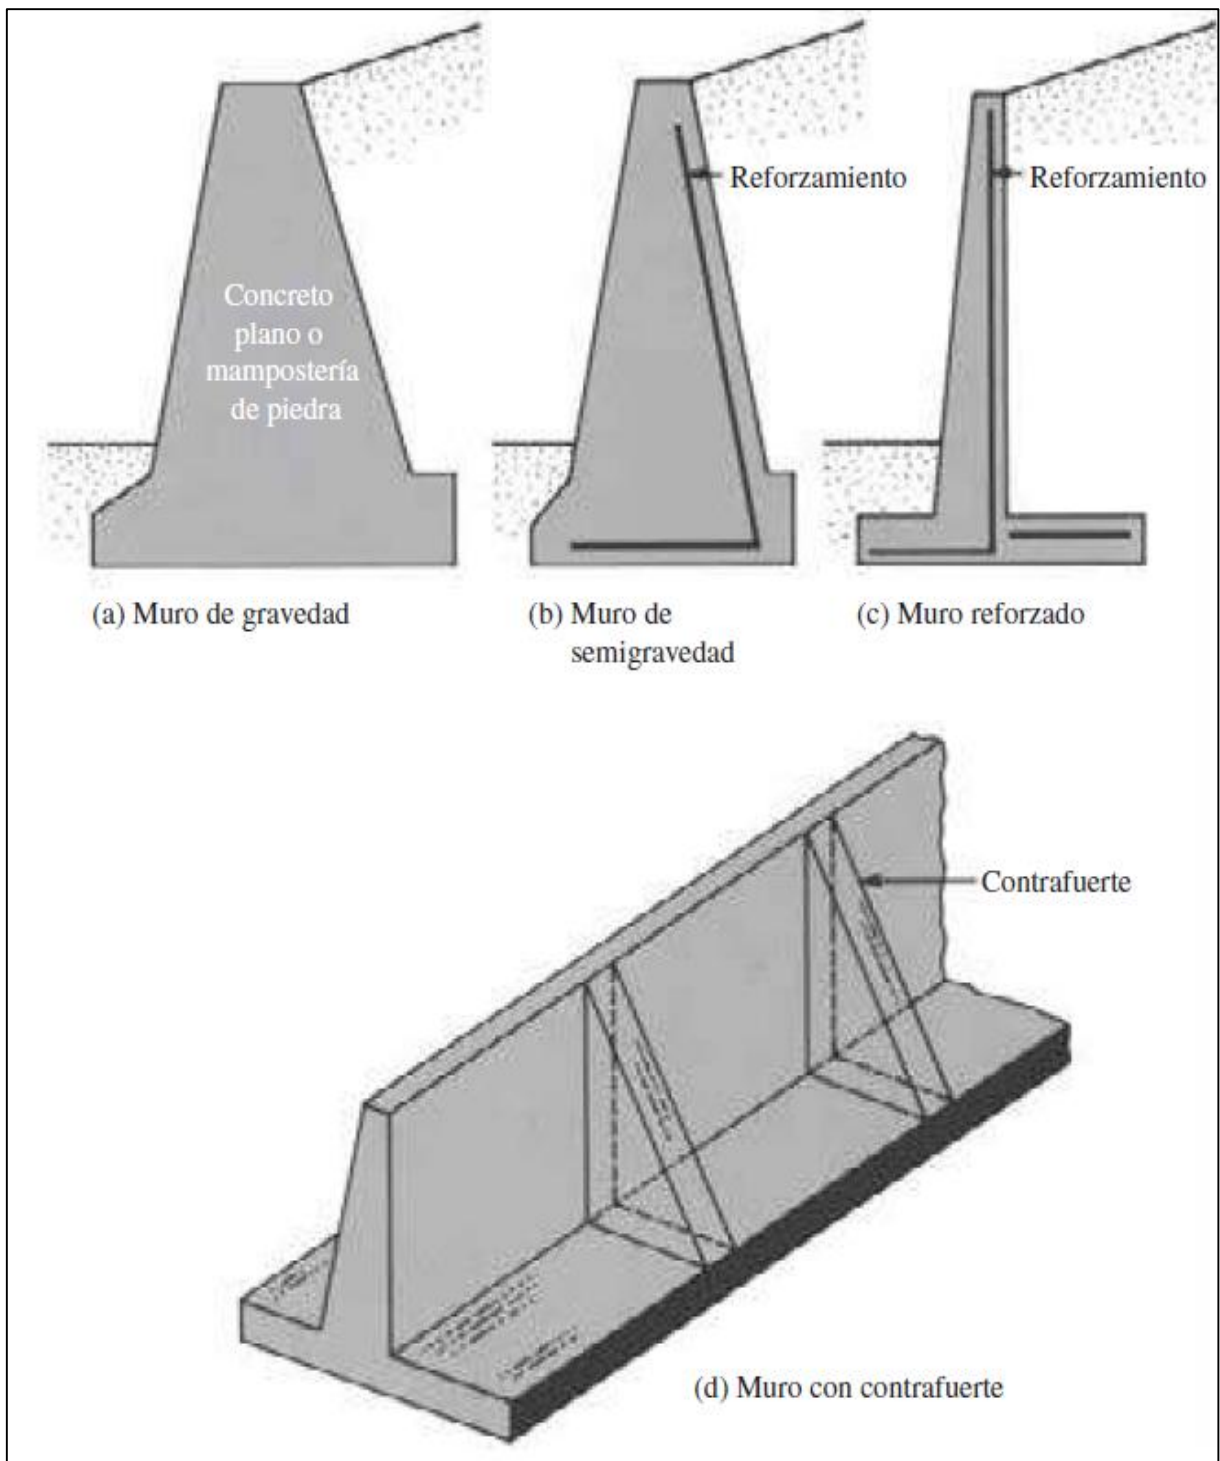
Tipos de muros de contención. Fuente: Braja. M., 2013.
